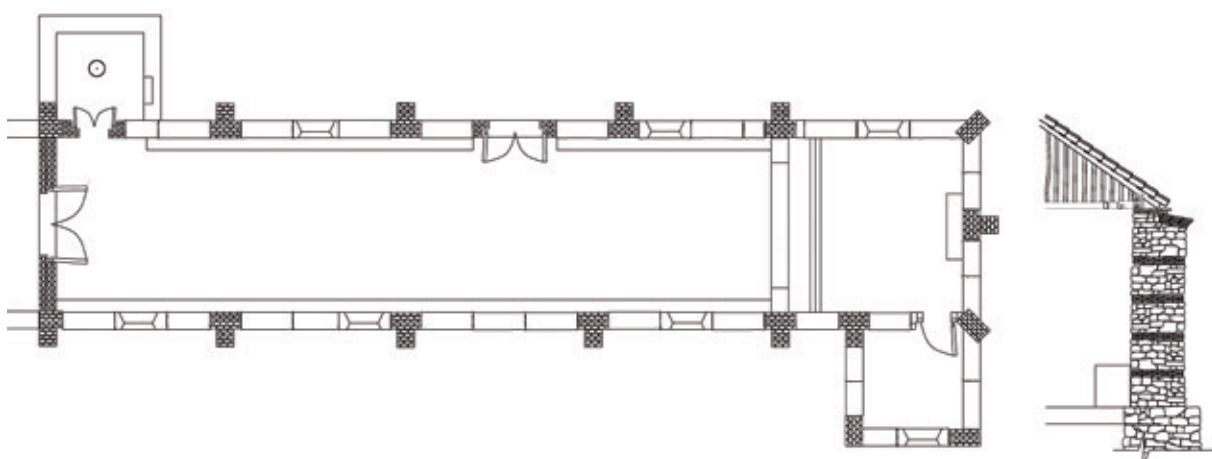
Traza de la iglesia de Zipacón con 3 contrafuertes en el testero. Planta general y corte del muro testero³⁵.
